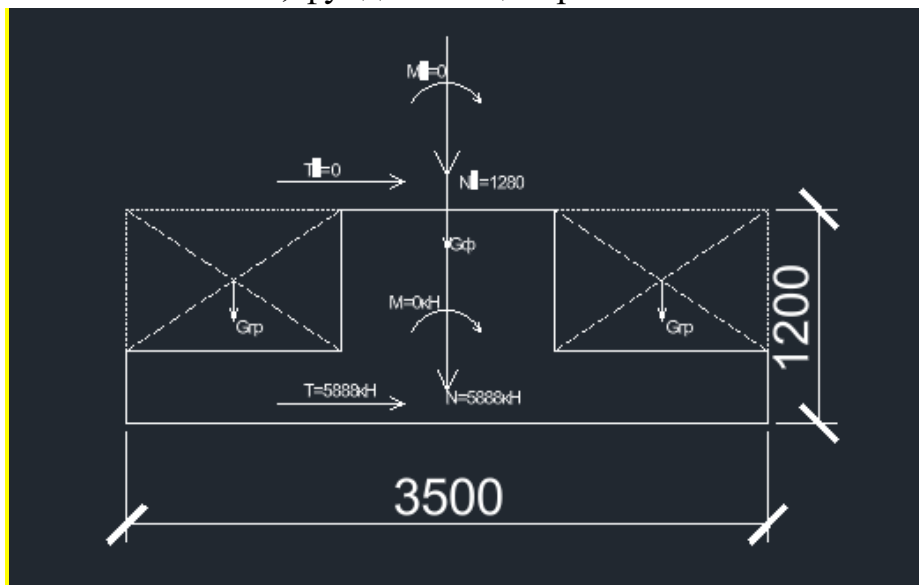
Попередня розрахункова схема фундаменту на природній основі
